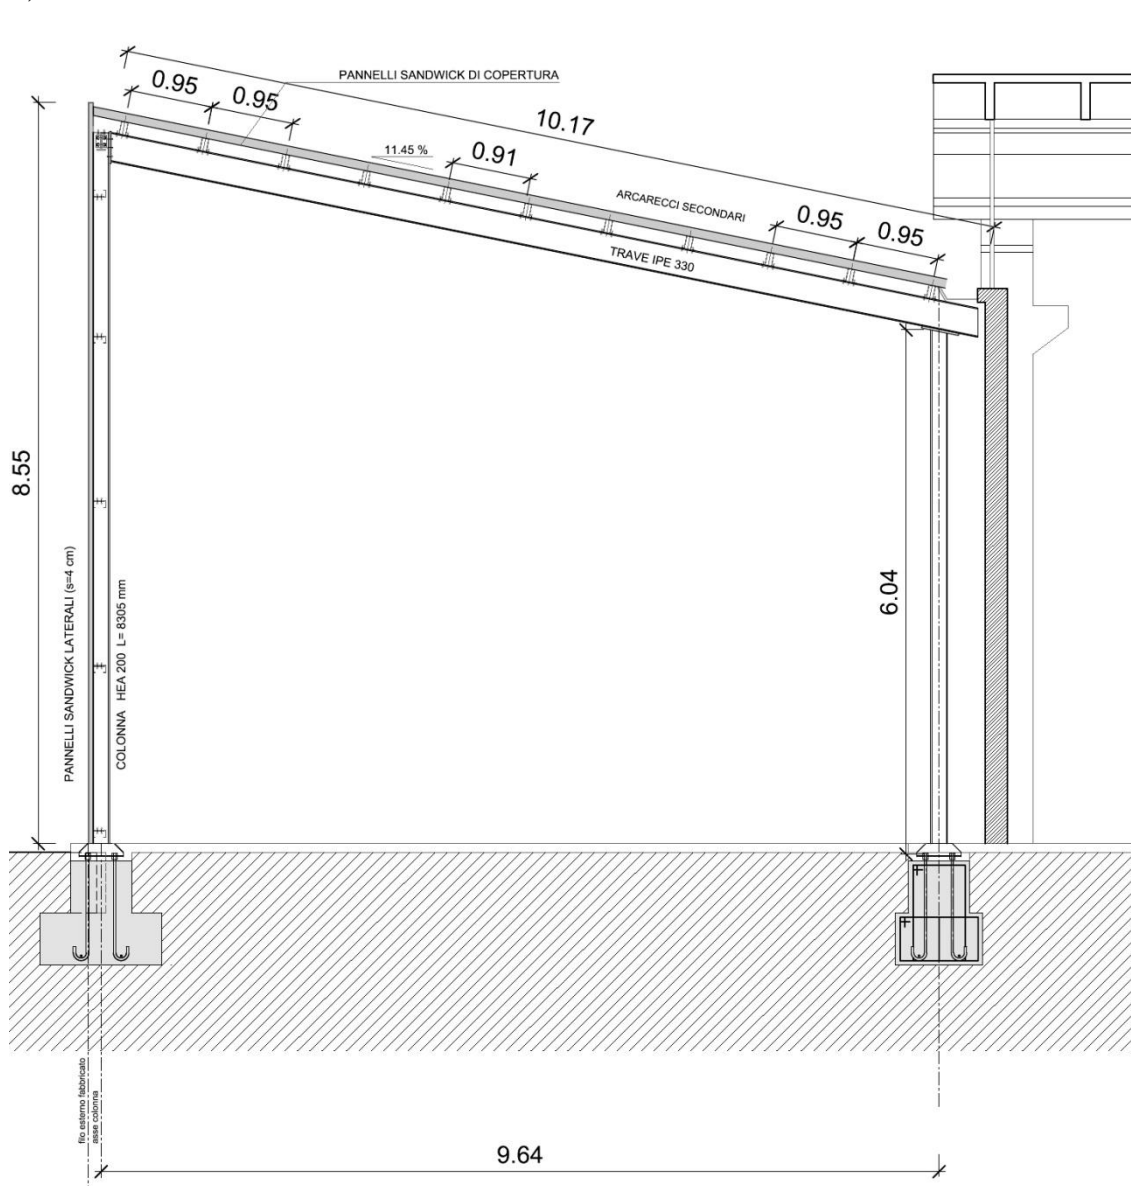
Particolare di A.2003.a.us.a.T01 - Struttura in acciaio - Sezione tipo
